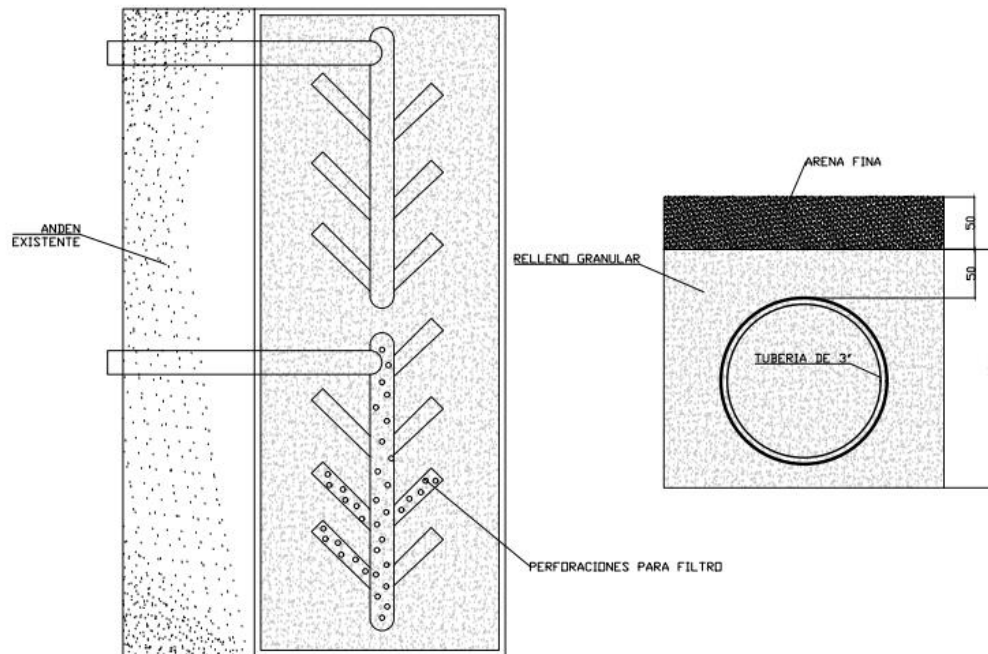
Modelo de Filtro para Zona Verde en tubería PVC
